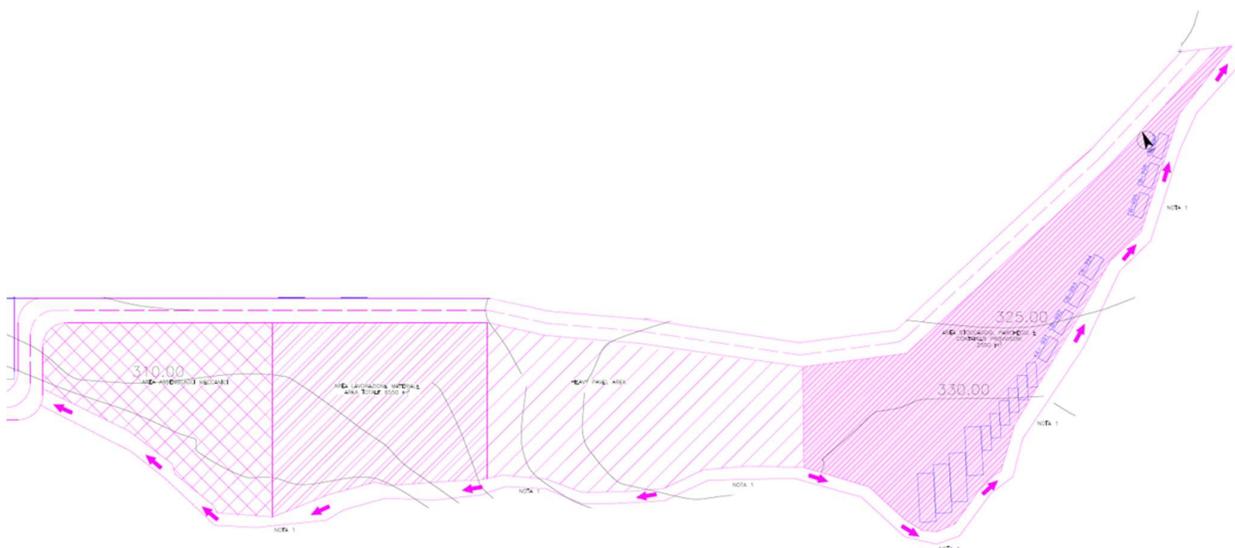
PLANIMETRIA AREA DI COSTRUZIONE
